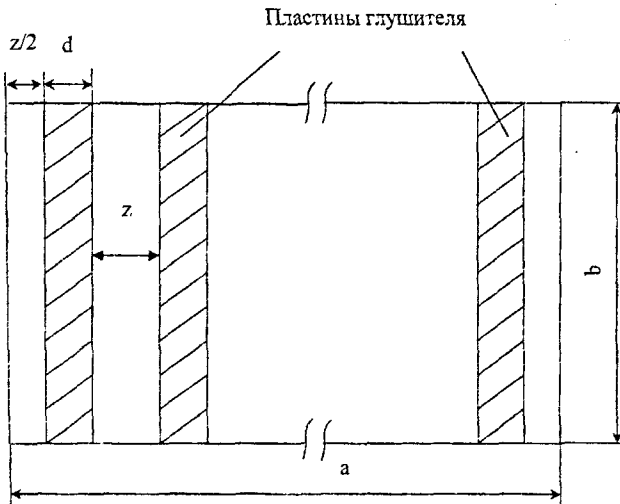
Схема расположения пластин шумоглушителя в сечении газотока
